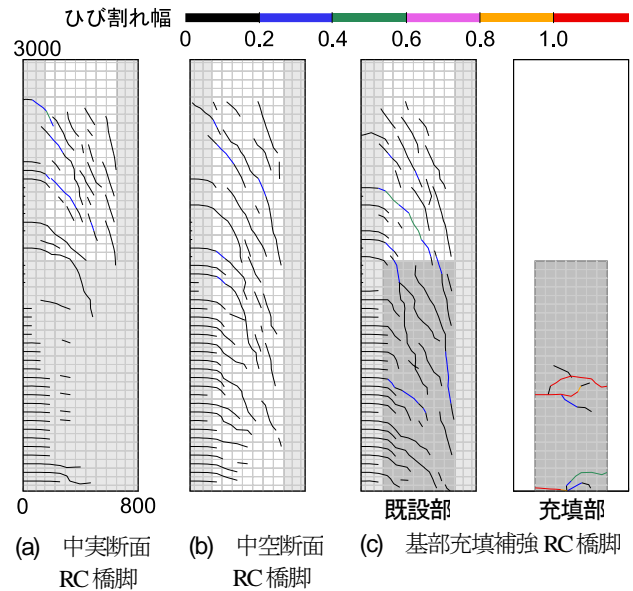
$1\delta y_0$ 時のひび割れ性状(Unit:mm)
